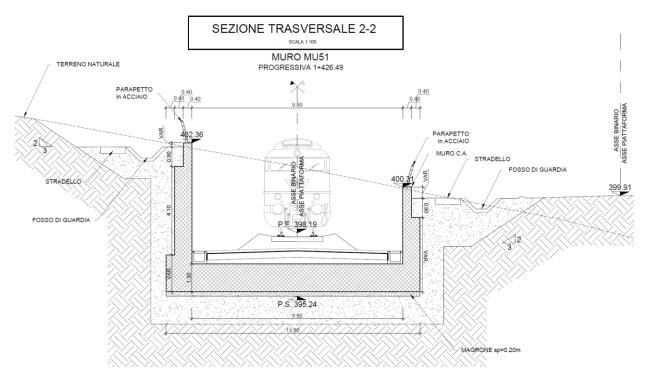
RI51: Muro a U MU51 - Sezione 2.
